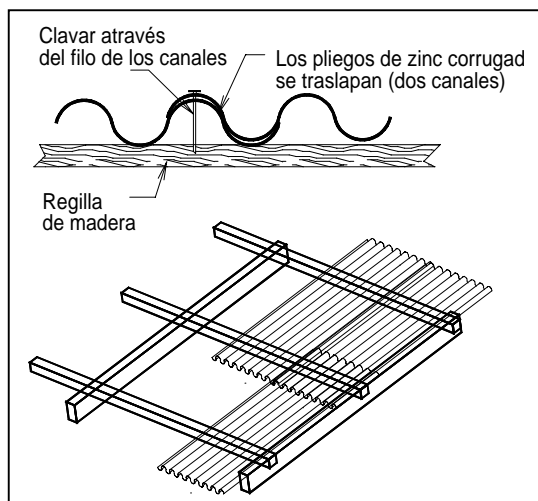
Técnicas recomendadas para el ensamblaje de techos de lámina de hierro galvanizado
